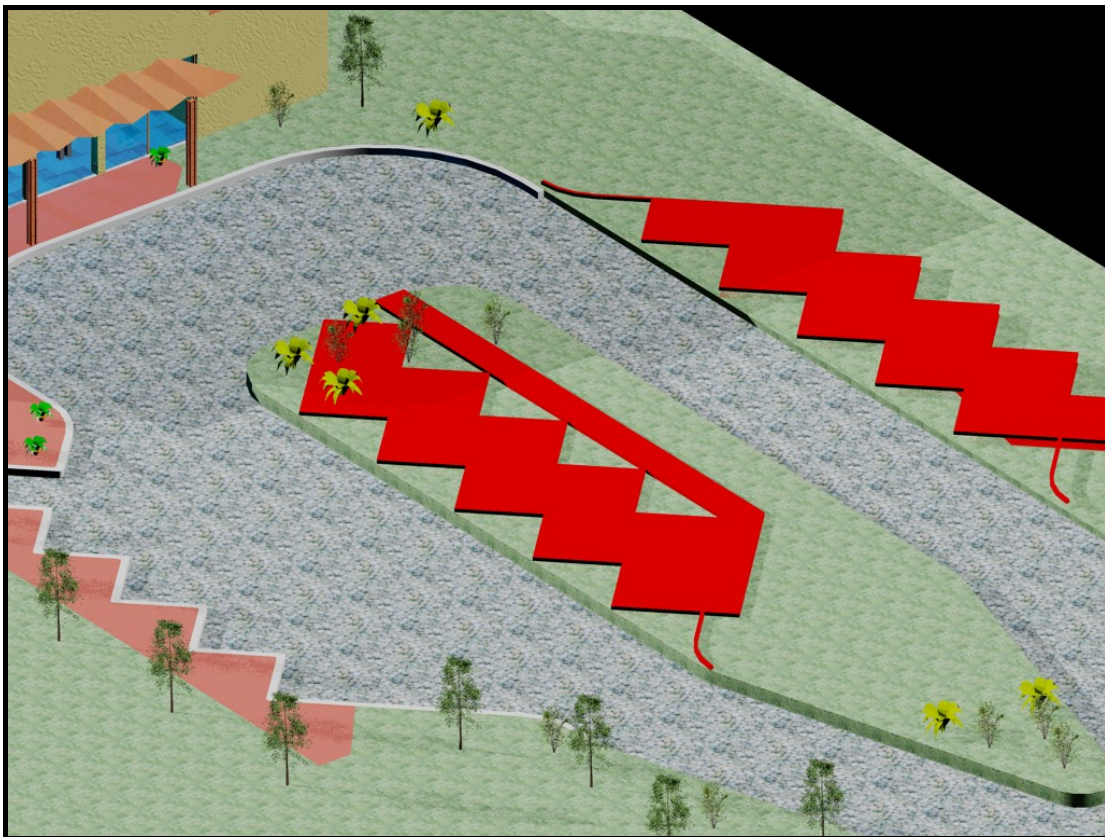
Futura distribución de las plazas de estacionamiento
